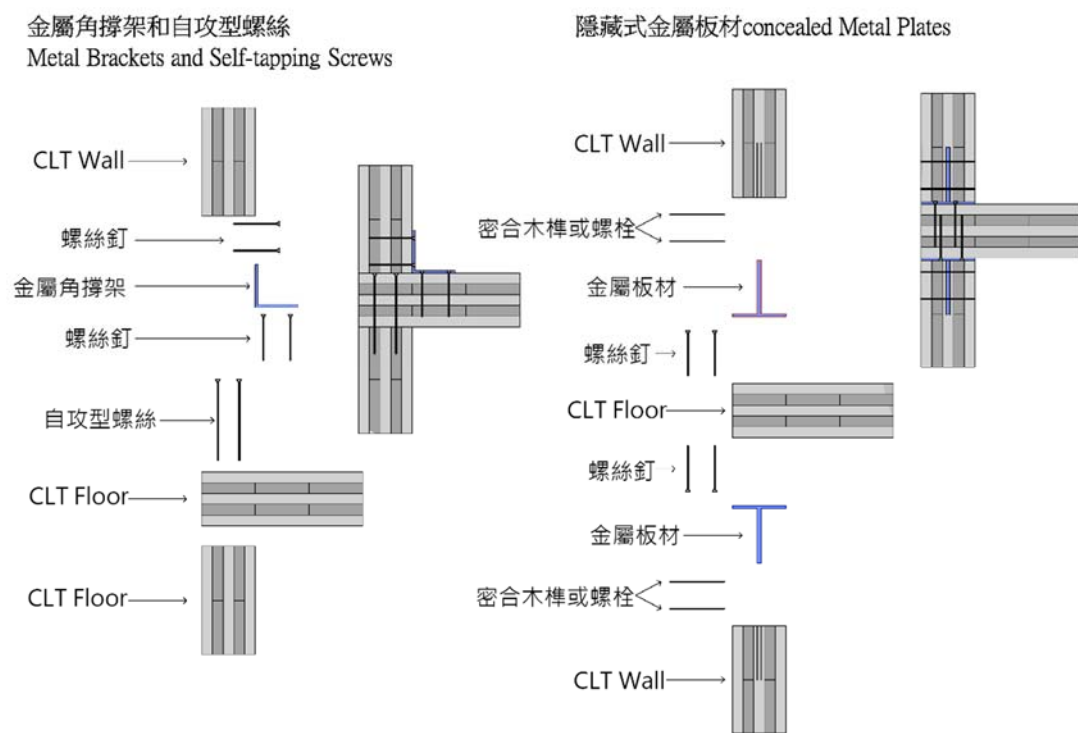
(a) Wall to Floor(Platform System)主要接合形式
